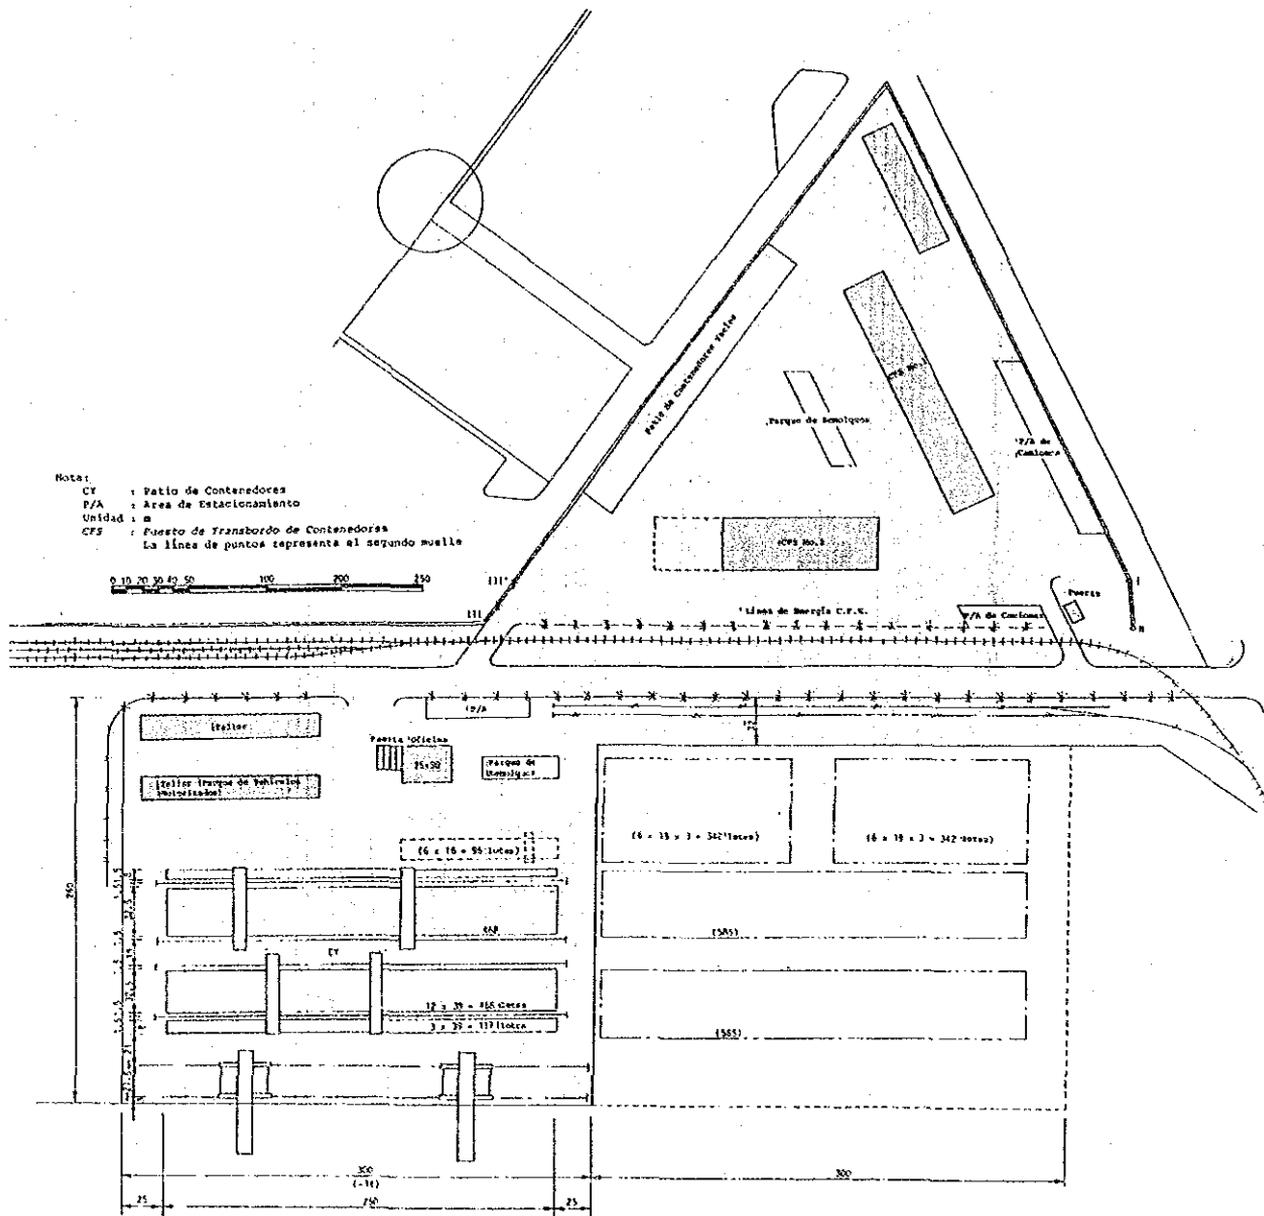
Plan de Disposición de la Nueva Terminal de Contenedores
